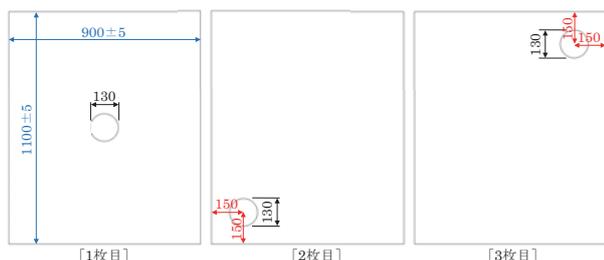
木材加撃体の加撃位置 (寸法単位: mm)
